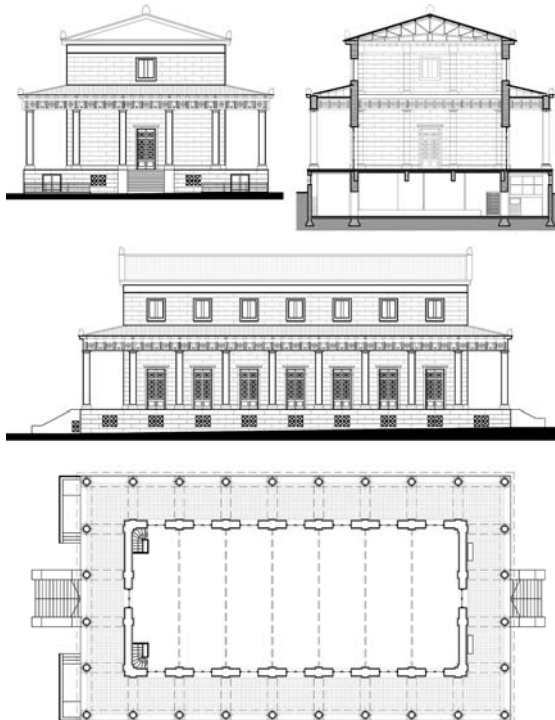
Edificio del Partenón. Planta, corte y vistas.
